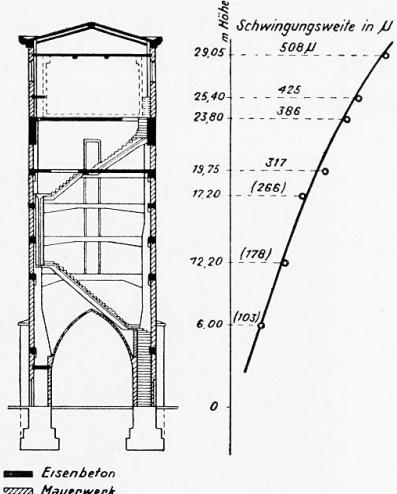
Château d'eau-Observatoire à Babenhausen — Wasser- u. Aussichtsturm in Babenhausen — Water tower and belvedere in Babenhausen.
